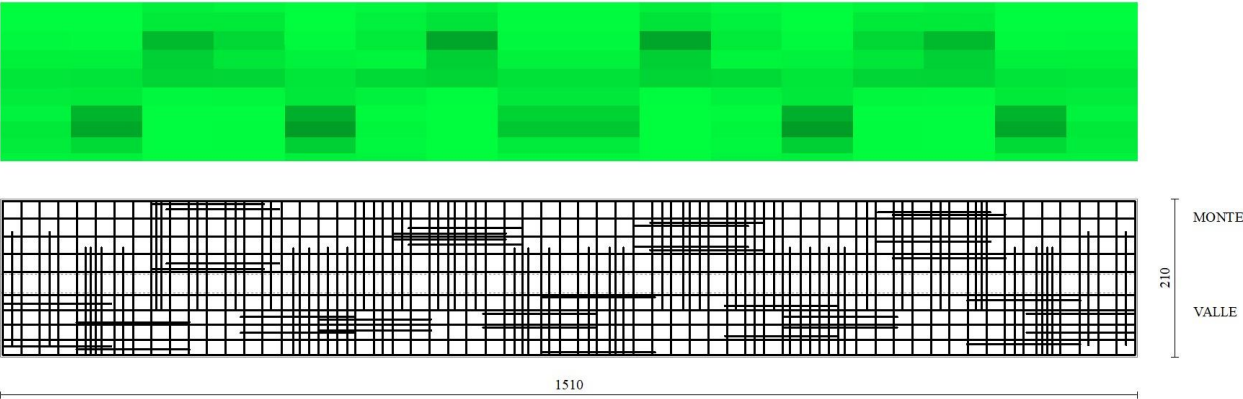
Piastra fondazione dir. Y (Inviluppo)
